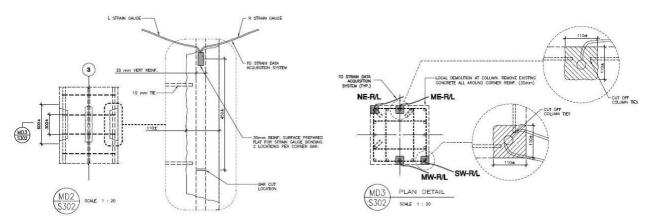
Esquema para ubicación de los extensómetros en la sección media de la columna.
